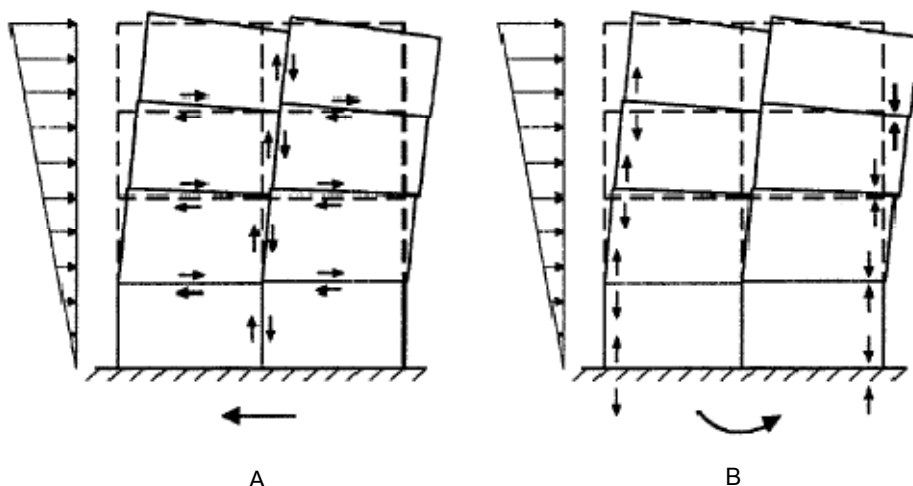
Acção no plano da parede, A – forças de corte, B – forças de tração e compressão (adaptado de [26])
